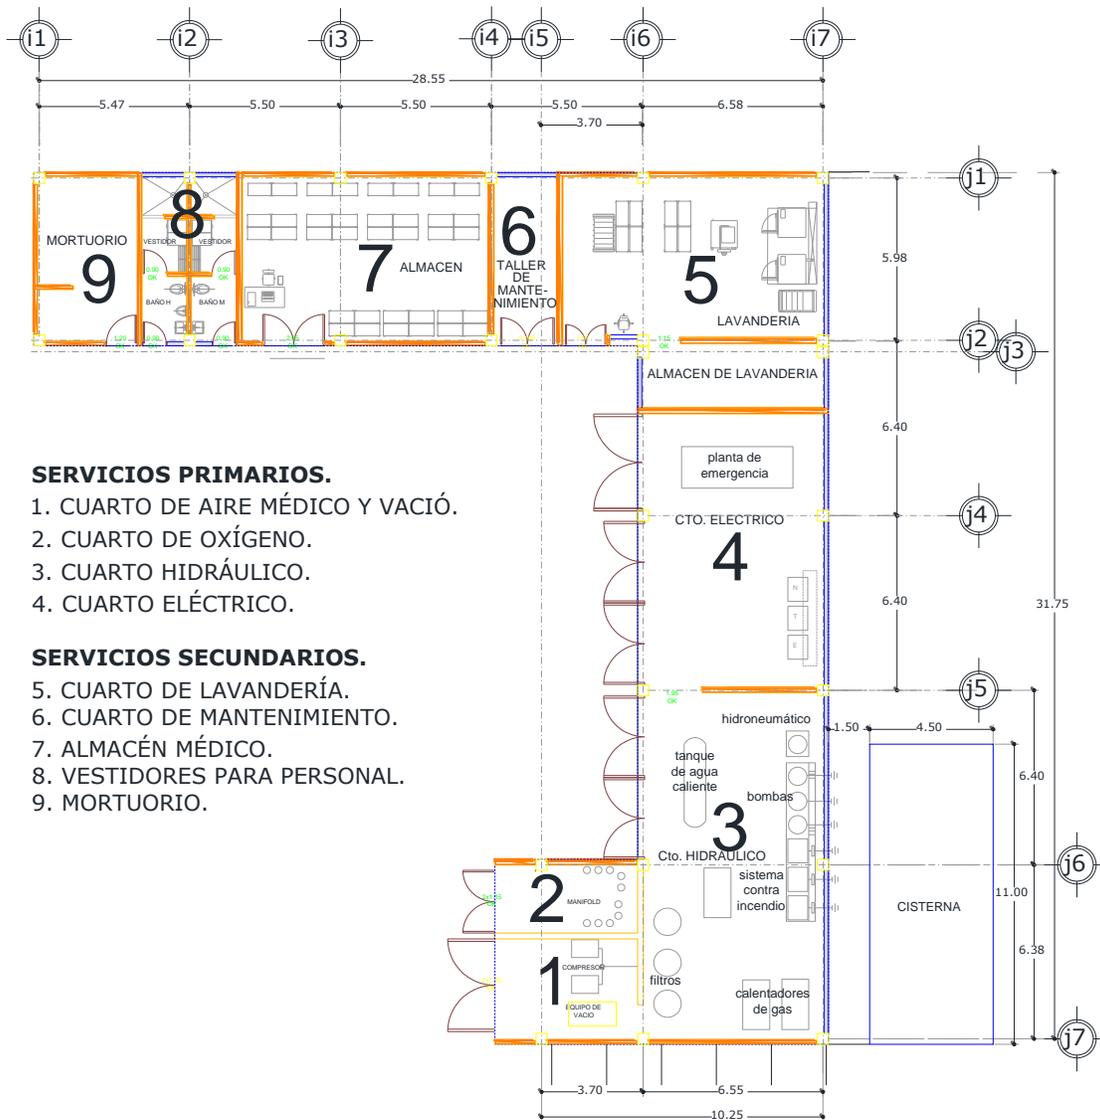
A.- Planta Arquitectónica de Distribución de Áreas de Casa de Maquinas.
